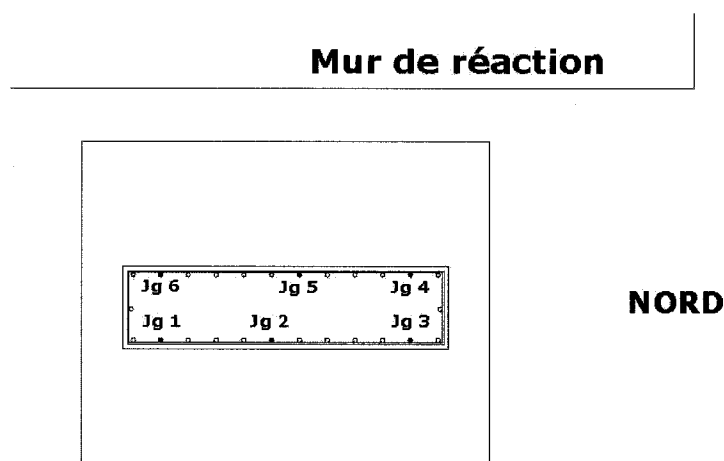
Schéma de l'emplacement des jauges sur les barres d'ancrage de la semelle des spécimens 3 et 4
